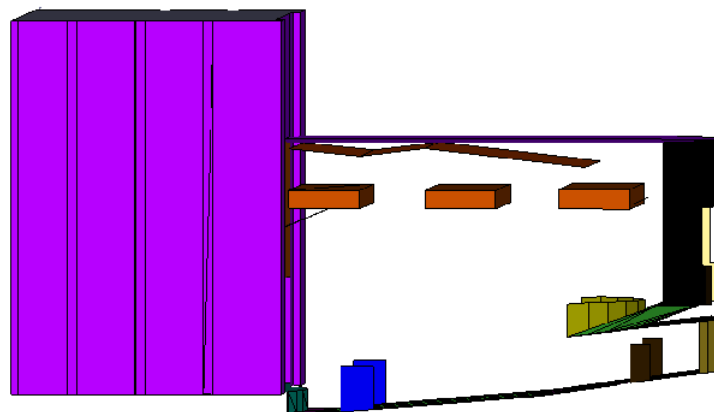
VISTA LATERAL CON DETALLE DEL TECHO INCLINADO
